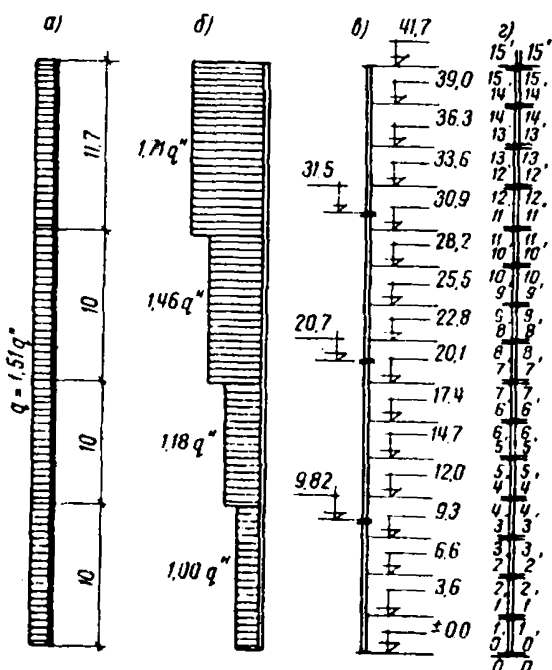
Схемы, принятые при расчете колонн здания Архива в период эксплуатации на горизонтальные нагрузки
